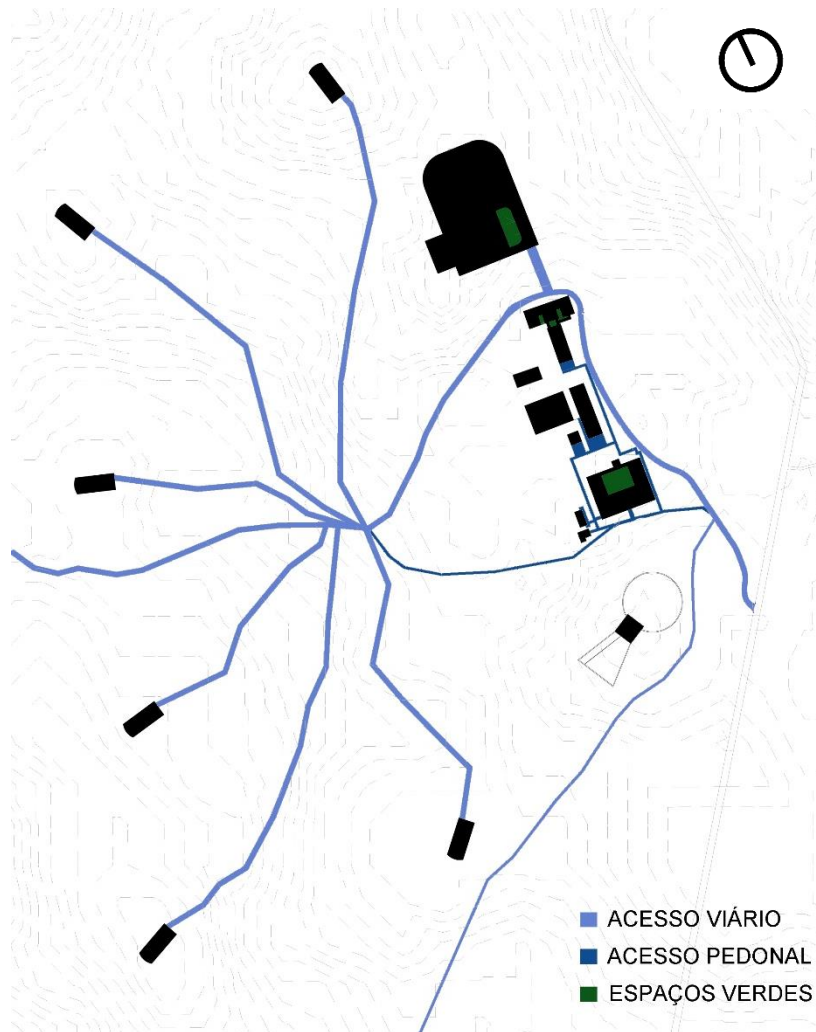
Planta esquemática da proposta em espaço rural
